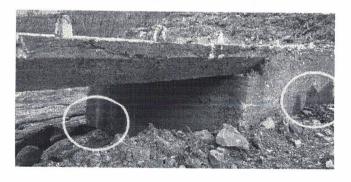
Infiltrações na Cabeceira - Laje L2
